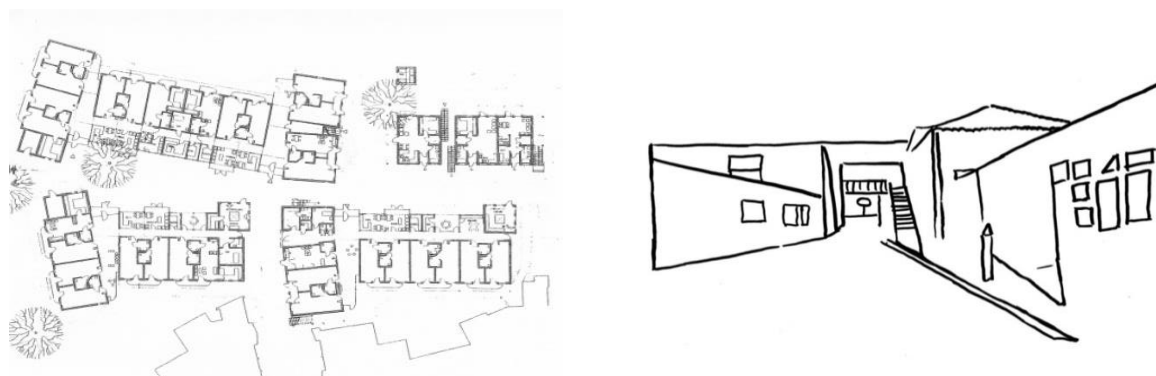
Typologie und Fassadenansicht des Entwurfs 4.
